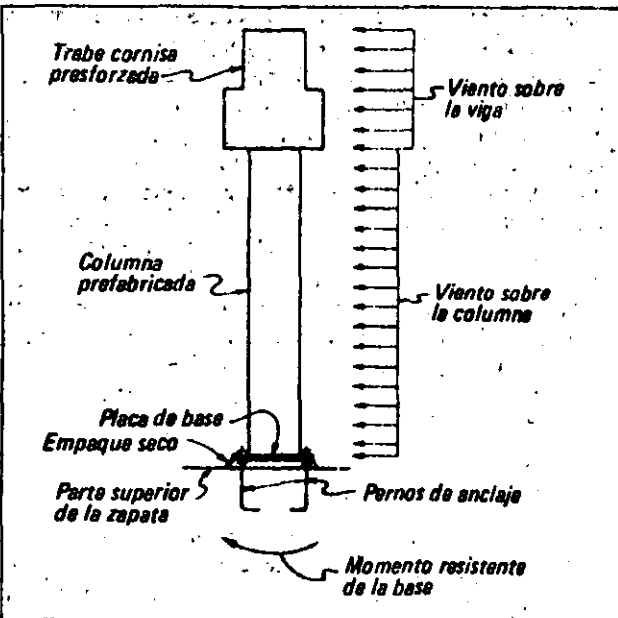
Efecto de las cargas de viento durante la construcción
